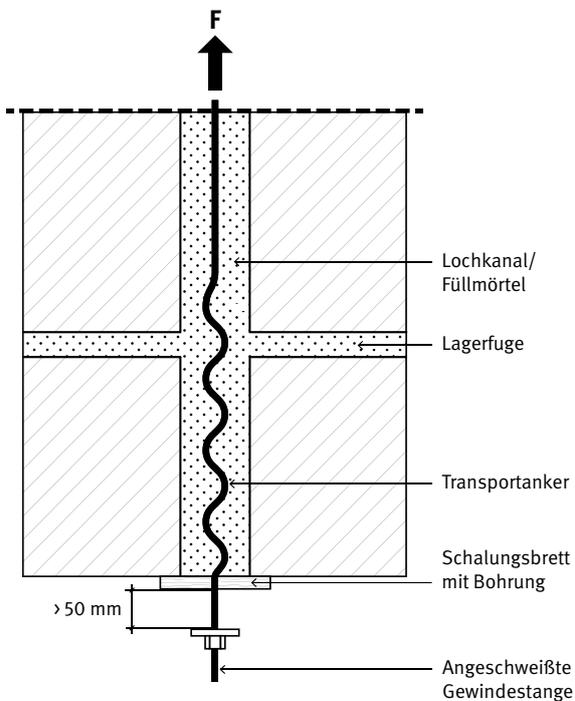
Beispiel eines Transportankers mit angeschweißter Gewindestange zur Befestigung der Messstellen zum Messen des Schlupfes am unbelasteten Ende
